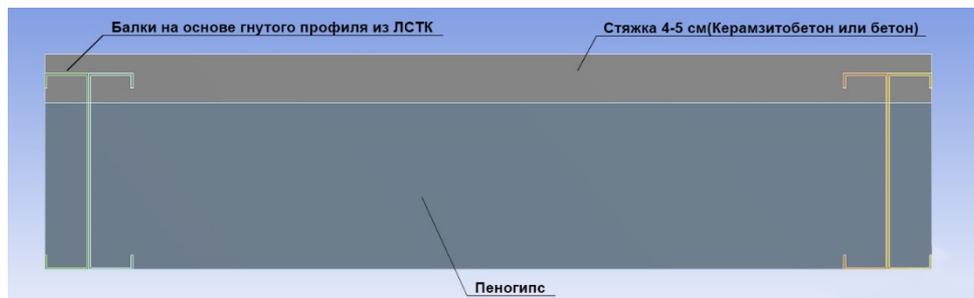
Плита перекрытия на основе ЛСТК и пеногипса
